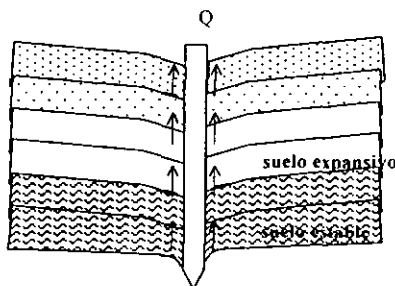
EMPOTRAMIENTO DE PILAS Y PILOTES
